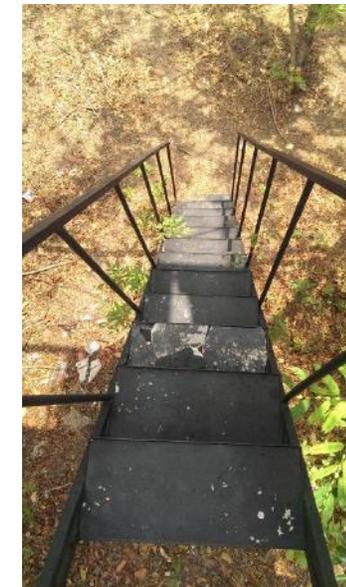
ESTADO ACTUAL DE LAS TORRES DE VIGILANCIA.
